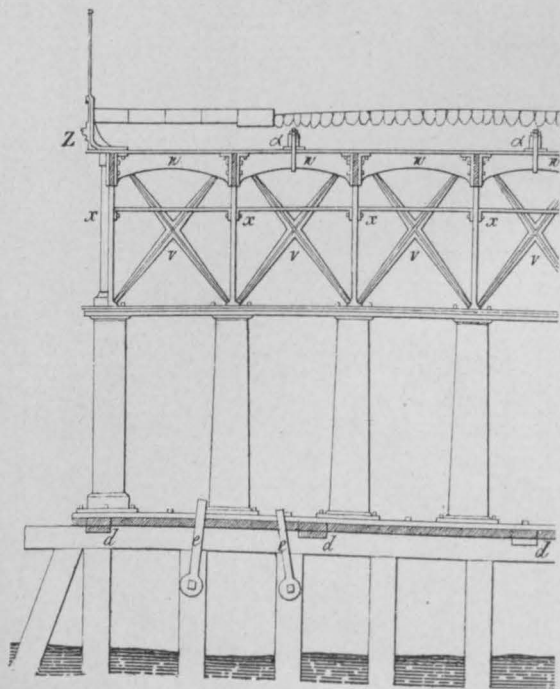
Querschnitt der Weidendammer Brücke mit der Ansicht der einfachen Pfeilerreihe.
